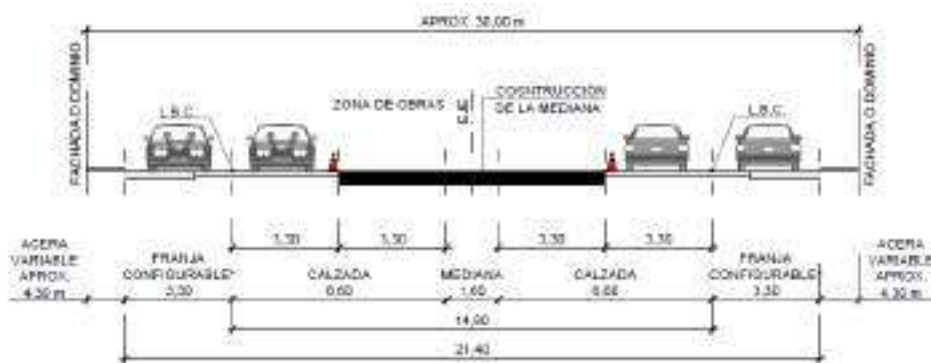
Detalle tipo para zonas de obra y tránsito en fase 5 de Desvíos Tipo 1.1.
